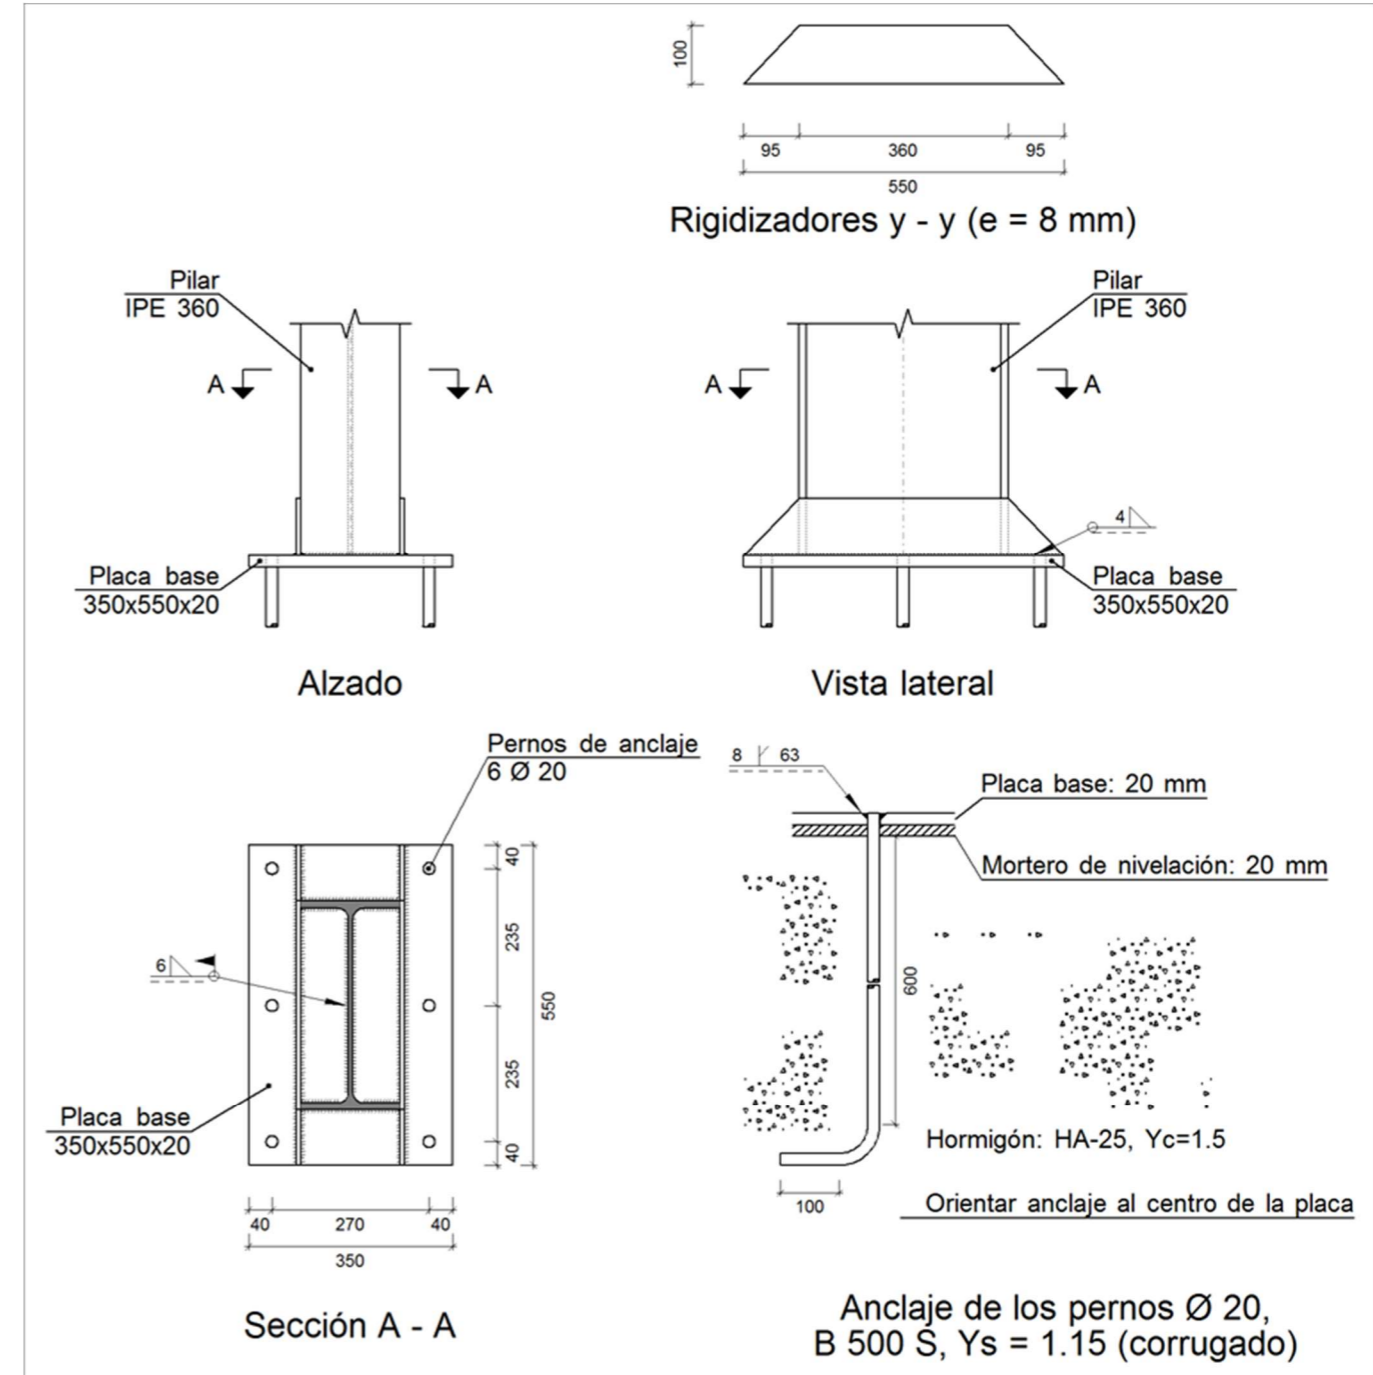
Detalle constructivo de la cimentación completa. Fuente: Cype3D.
